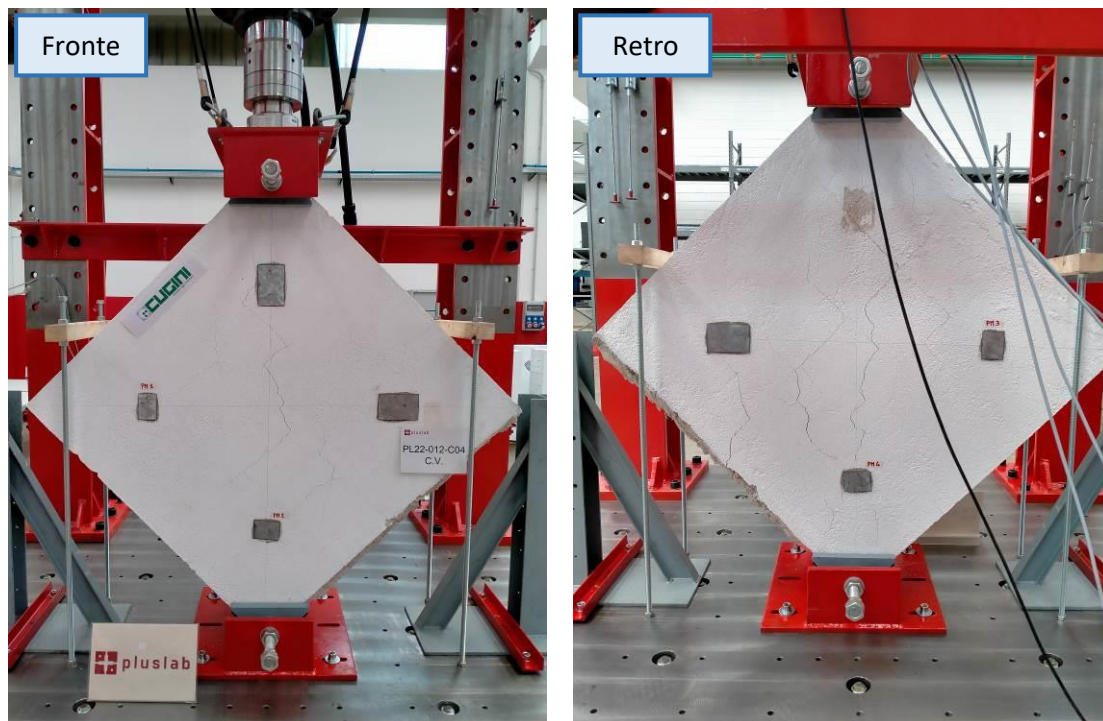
Campione C03 - CALCEVITA STRUTTURALE dopo la prova
